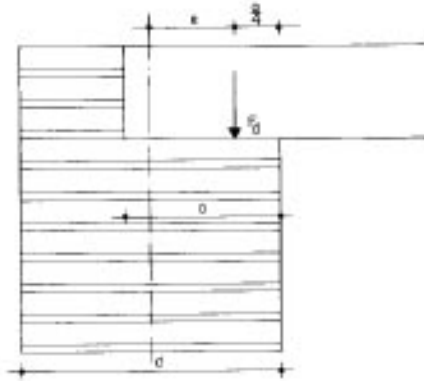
Forjado sustentado en un muro extremo, sin muro de carga sobre el forjado
